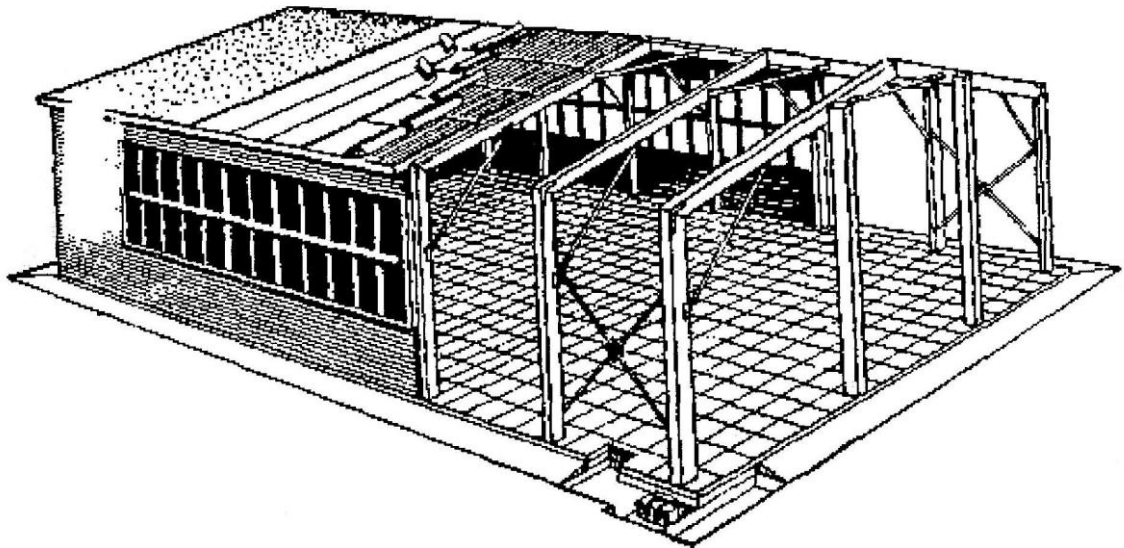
Швидкоспоруджувана будівля серії УТС 420-12
